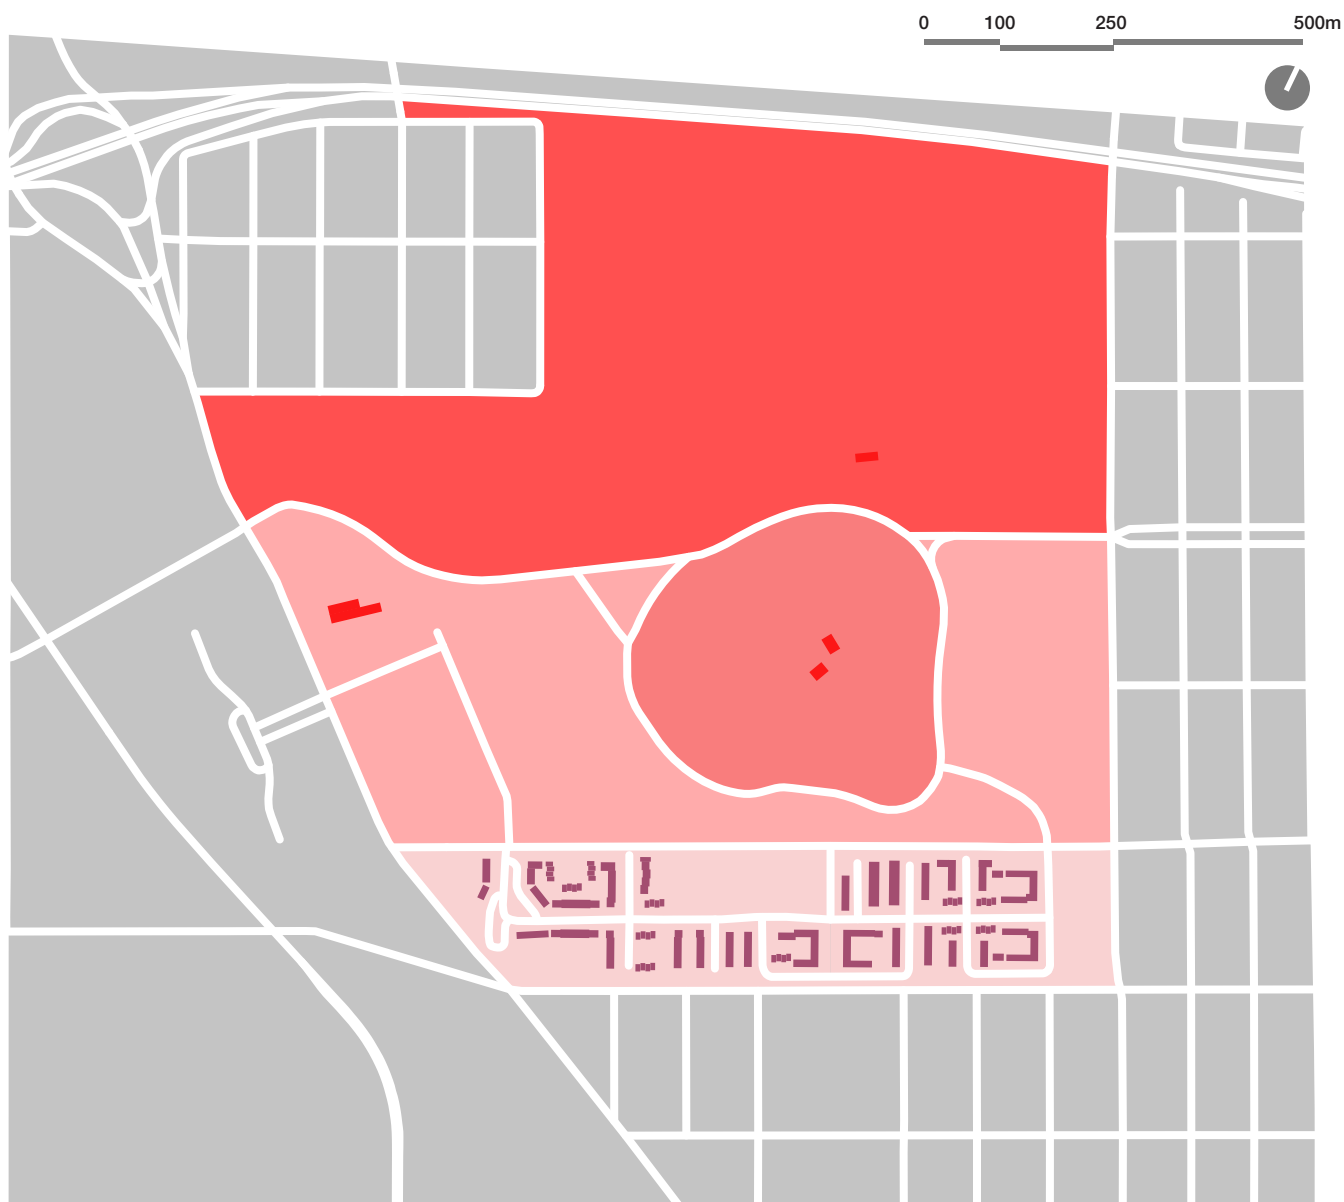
Implantação do projeto habitacional Parkside | Escala 1:10.000
